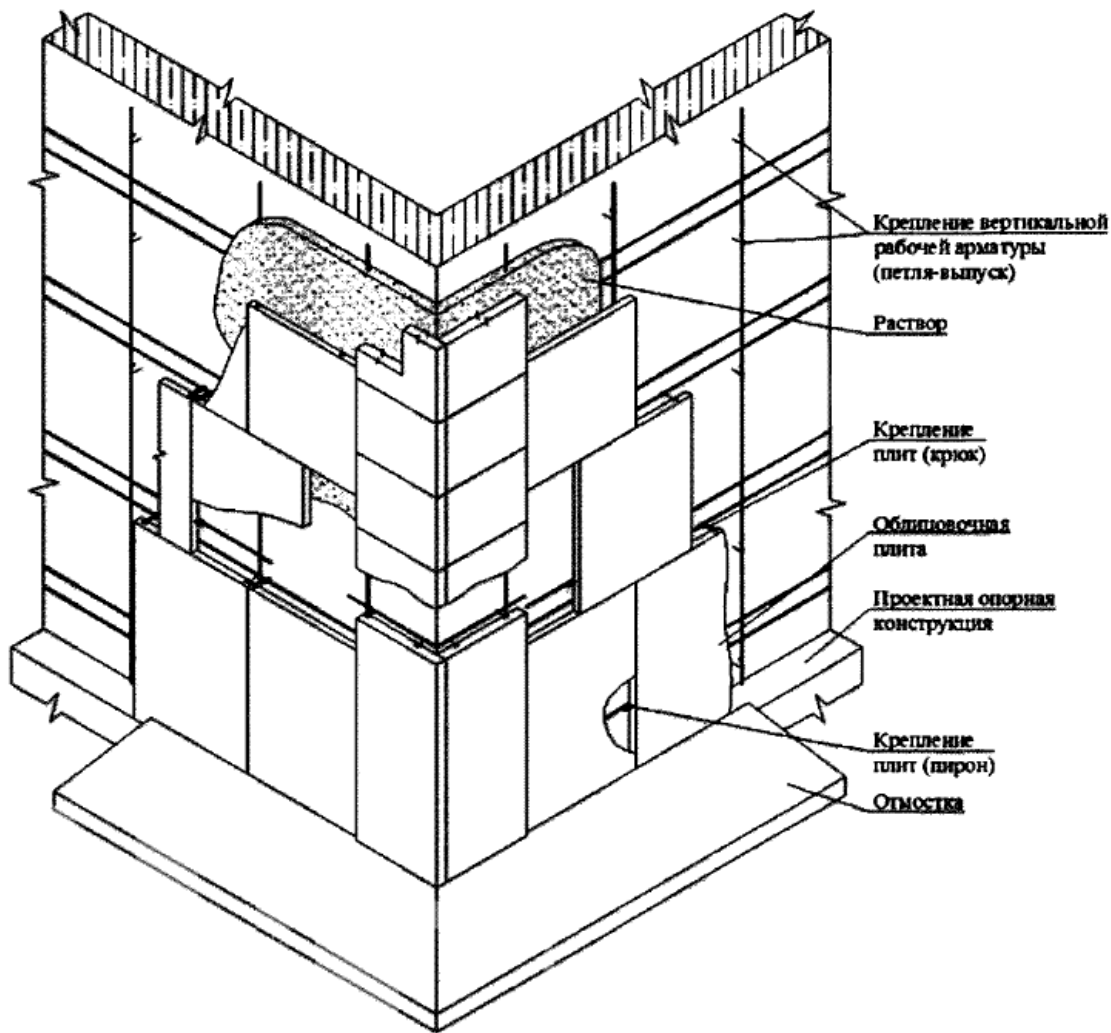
Схема крепления облицовочных плит на угловом участке
